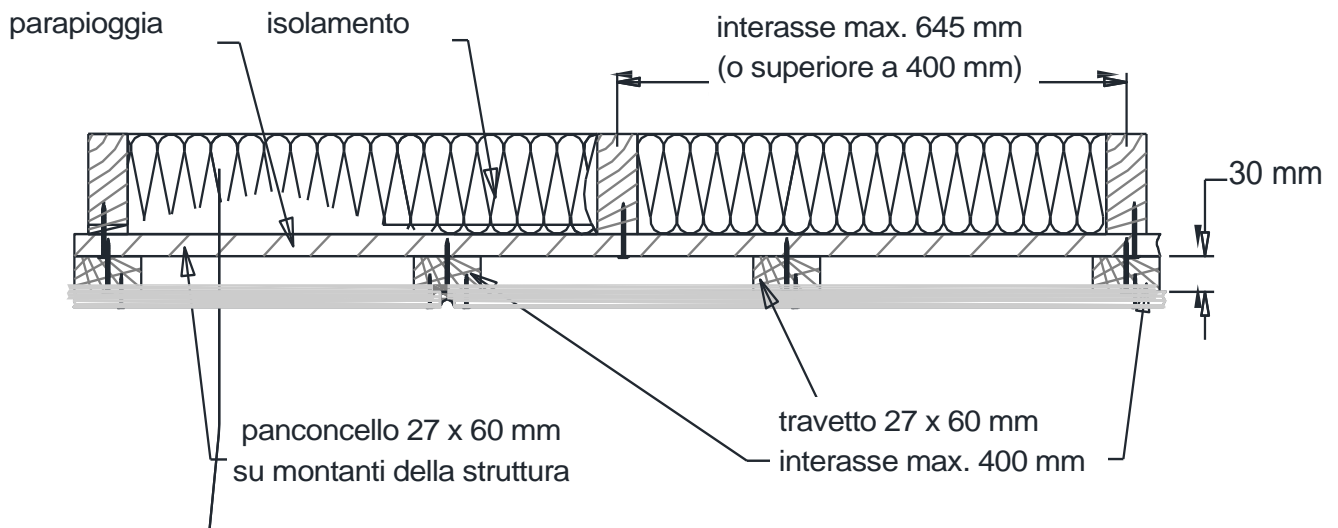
Sezione orizzontale su costruzione con struttura in legno – Posa orizzontale (interasse > 400 mm) – Posa su doppia travatura
